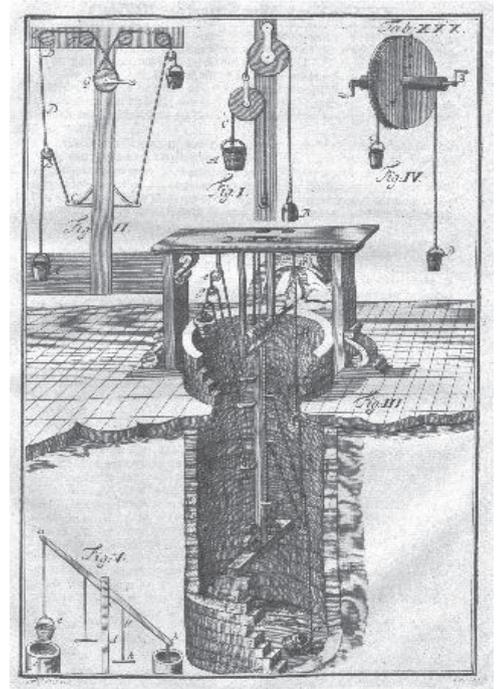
Schöpfbrunnen mit gemauertem Schacht, Brüstung und Dach, Zeichnung von 1724
